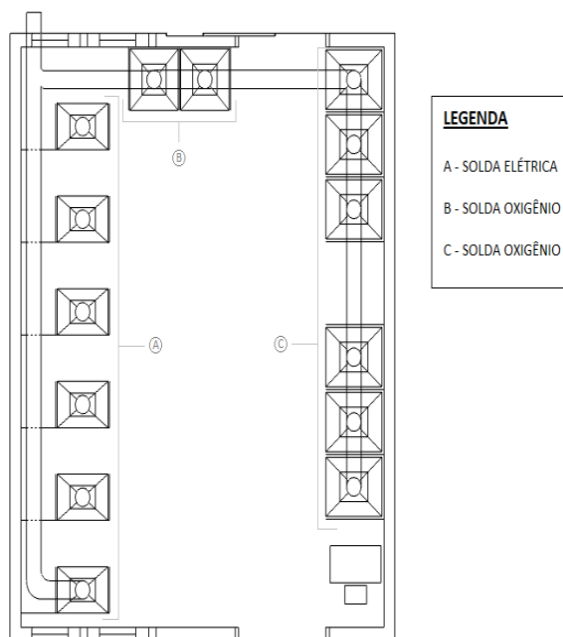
Sistema Proposto. Fonte: Elaborado Autores
